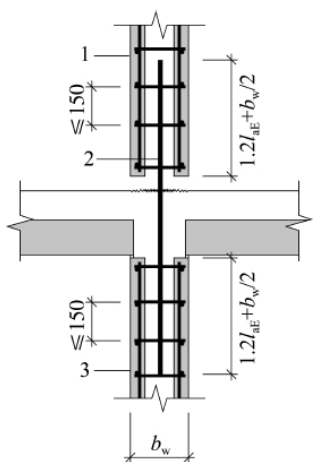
成型钢筋笼叠合板式剪力墙水平接缝处单排连接构造
